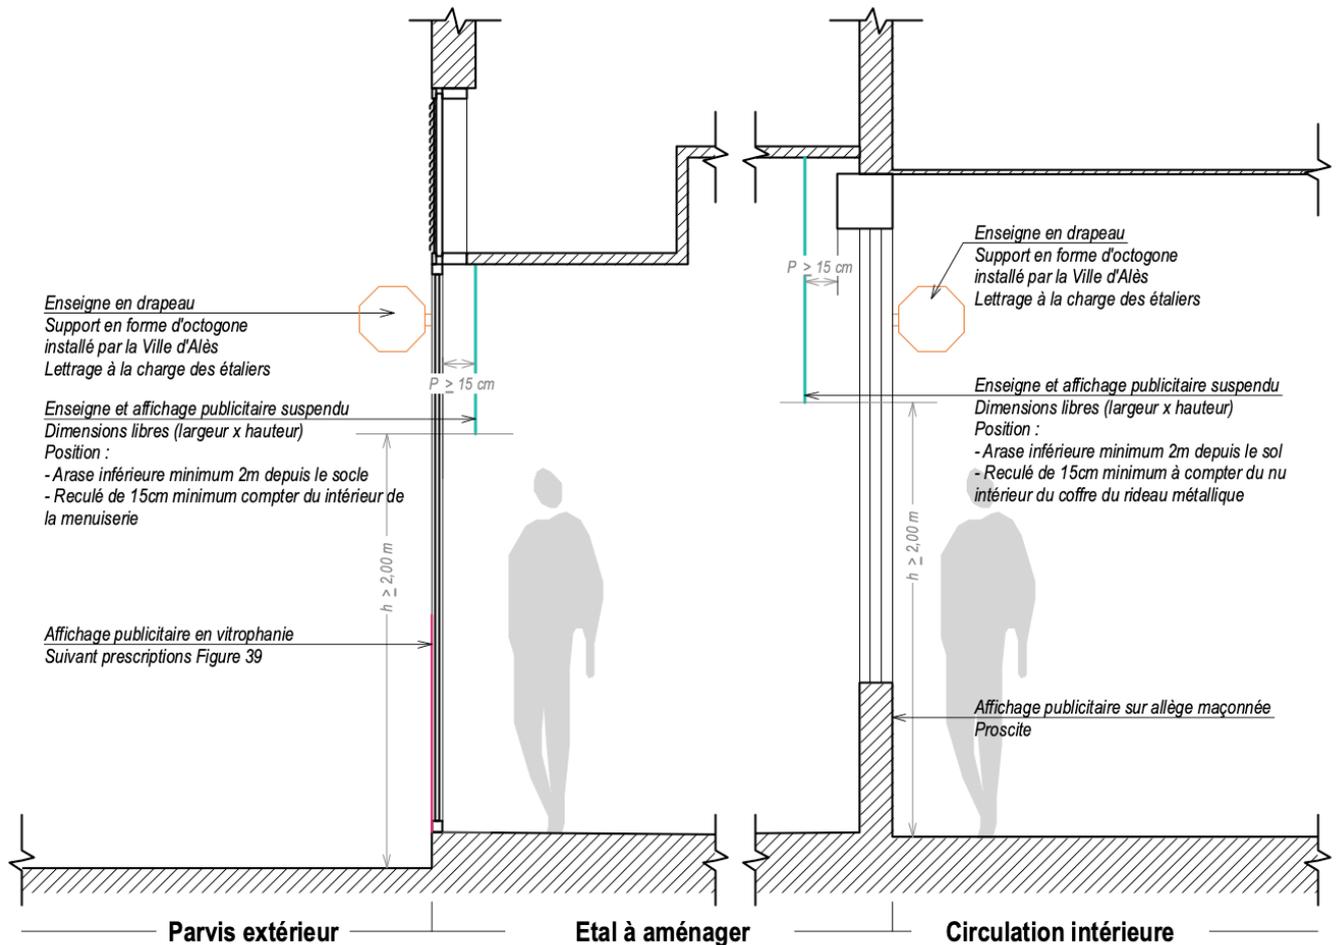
Coupe schématique de la localisation de la signalétique en façades extérieure (gauche) et intérieure (droite)
